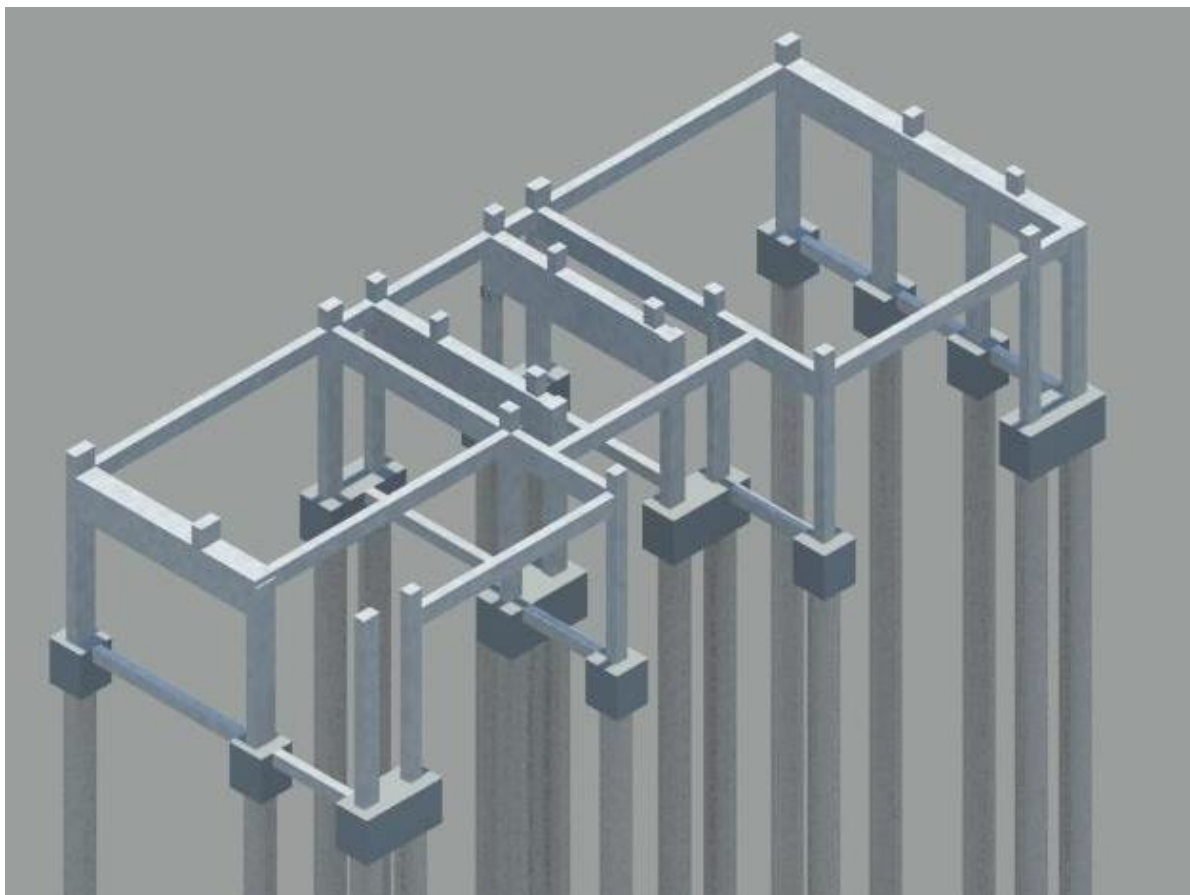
Perspectiva da estrutura do edifício (apenas pilares e vigas) com destaque para o pavimento térreo
